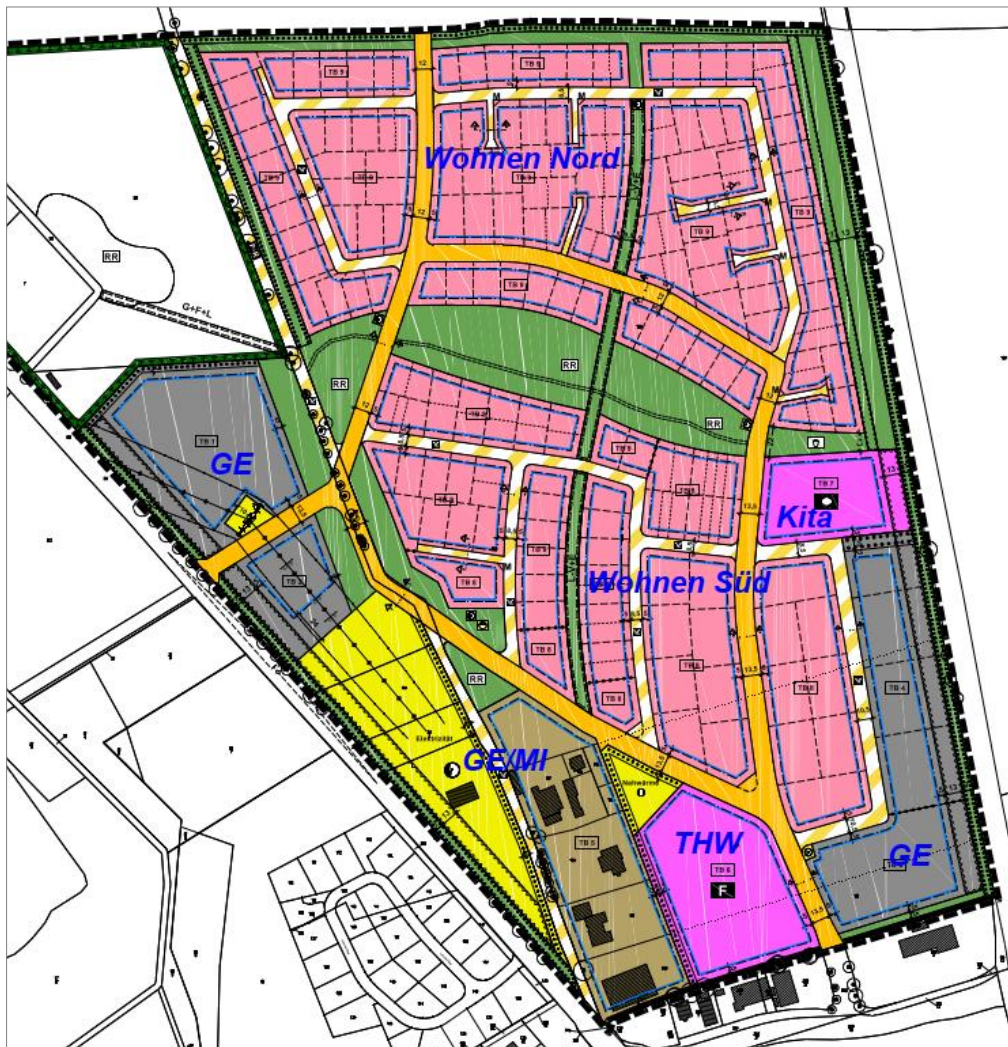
Lageplan (o.M., Ausschnitt B-Plan 74.2 Stadt Lauenburg [1])
